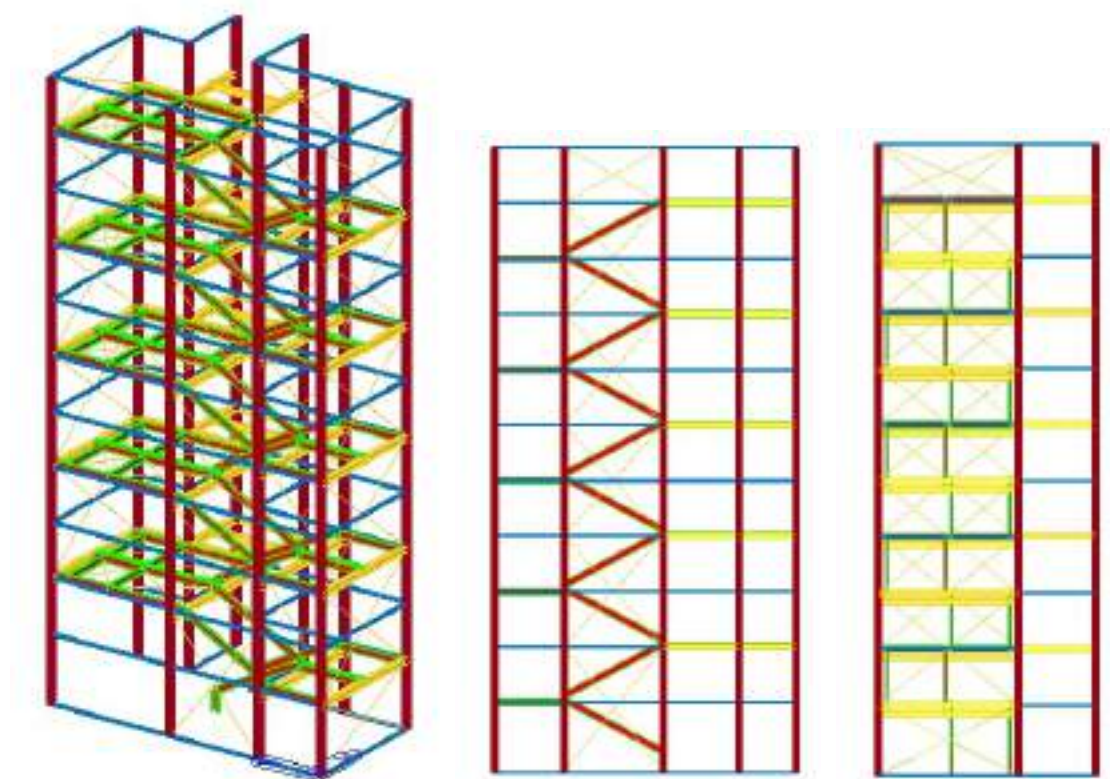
Viste estruse assonometria, prospetto direzione x e direzione y
